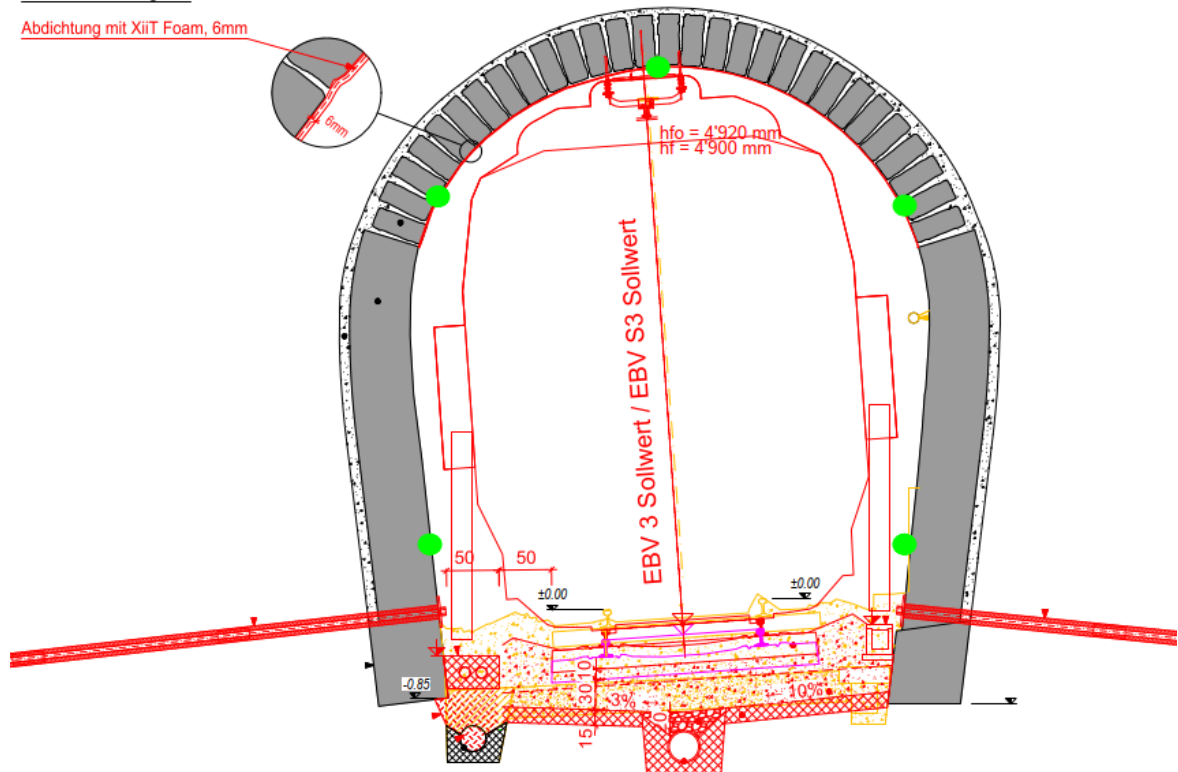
Lage Messpunkte (grün) im Tunnelquerprofil
